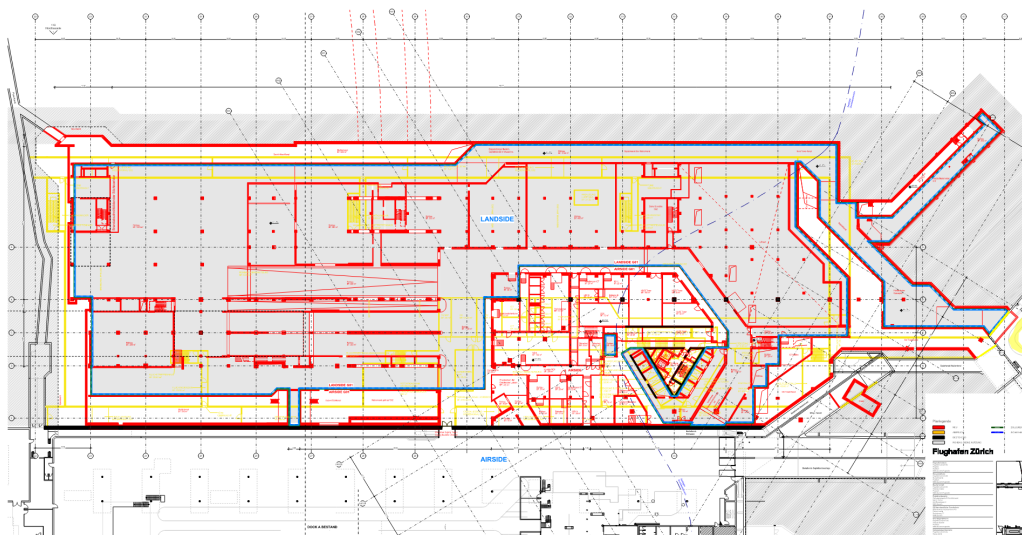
Aktualisierter Grundriss Untergeschoss G01
